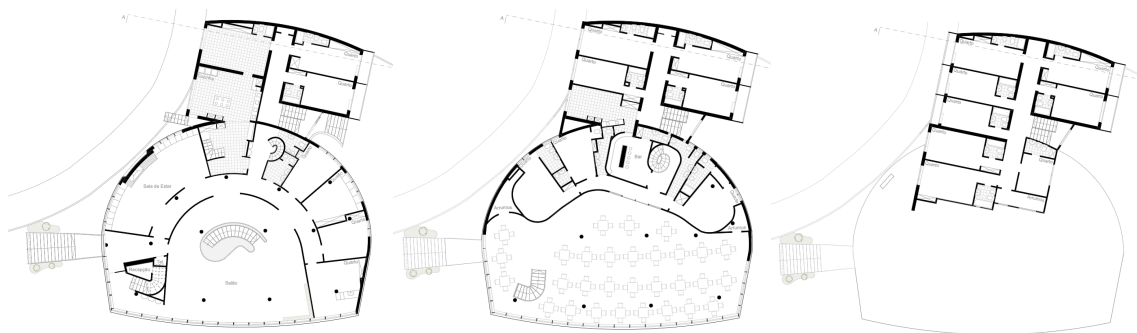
Reconstituição da planta piso 2, 3 e 4, 1967
